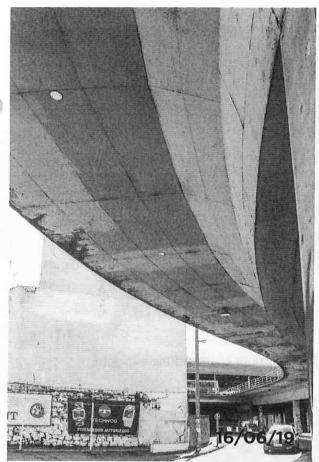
Vista geral frontal inferior da Passarela, detalhe ausência de pingadeira laterais, processo de infiltração e armaduras expostas.
